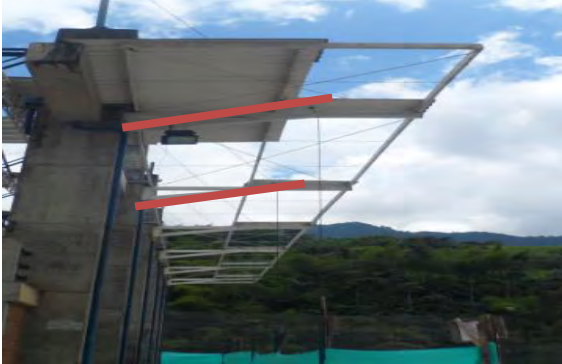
Cerchas secundarios desmontadas en cubierta metálica.
